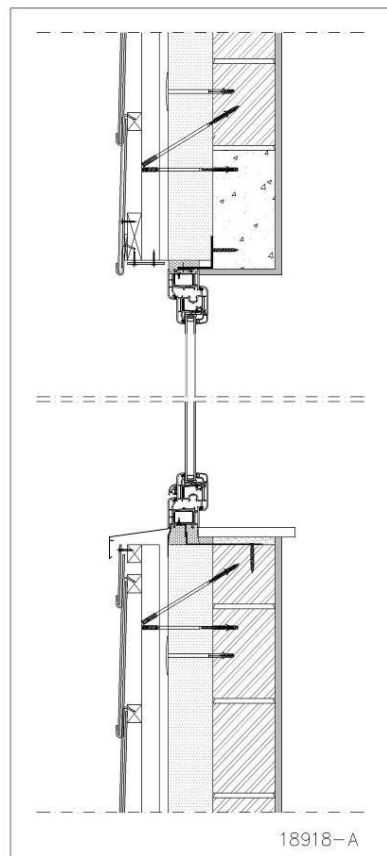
Exemple coupe verticale d'une fenêtre en retour
